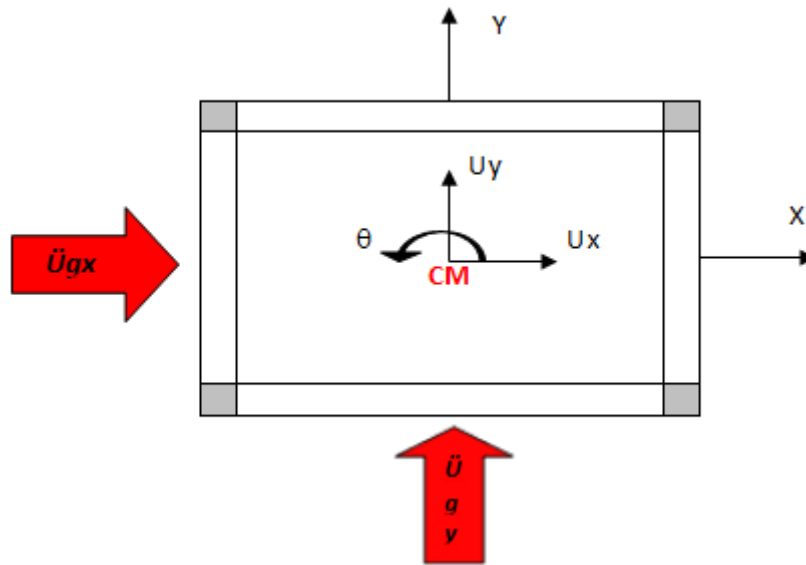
Planta de un edificio con gdl's en el CM (acción sísmica bi-direccional)
